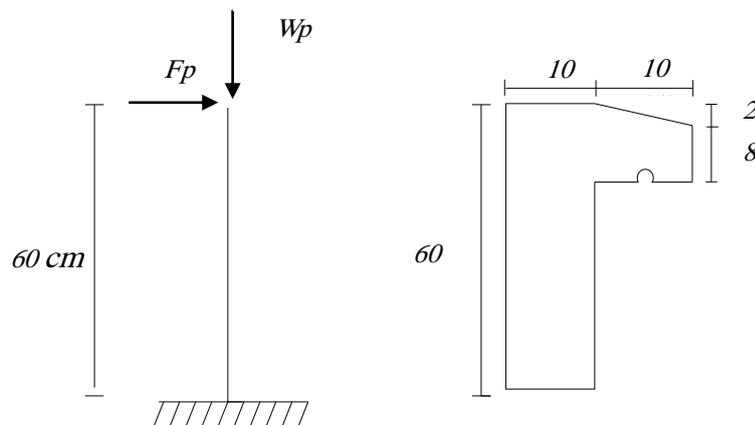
Schéma statique et dimensions de l'acrotère.
